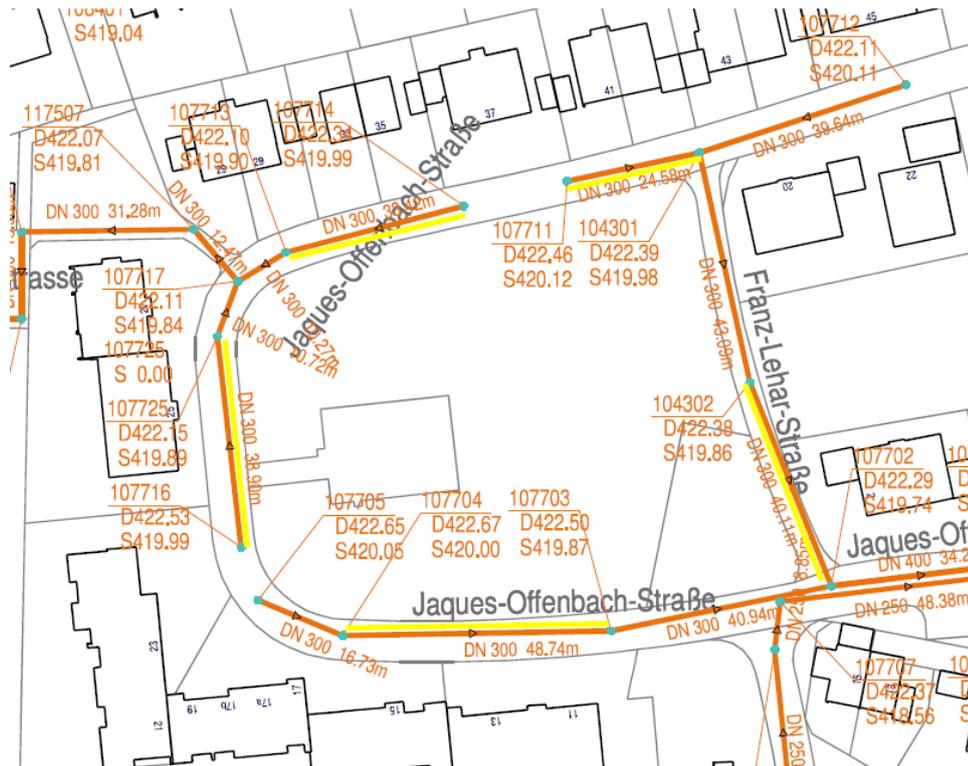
Planausschnitt Abwasserkanal (Quelle: Stadt Freilassing)
